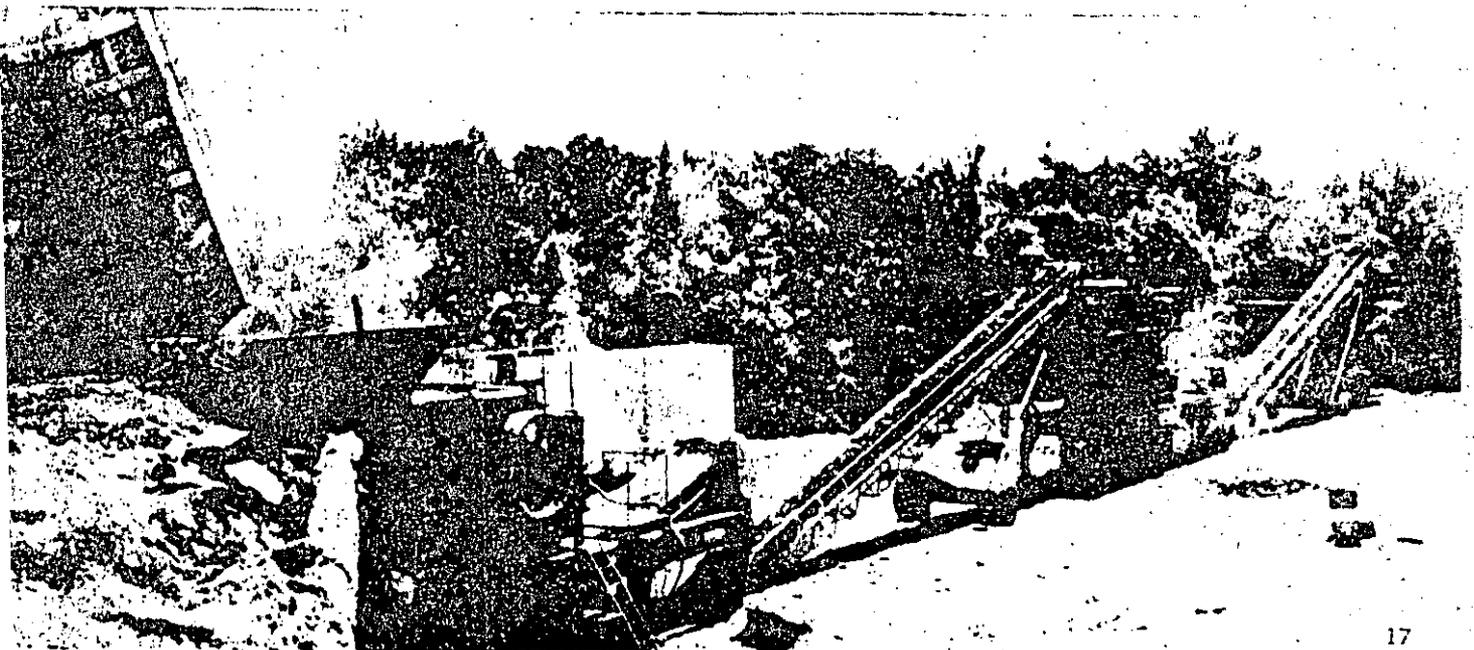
Planta portátil de trituración y cribado por vía seca, mostrándose la descarga de roca del camión a la tolva de recepción del grupo primario y las bandas transportadoras portátiles de conexión del grupo primario al secundario, y del grupo secundario al terciario.
